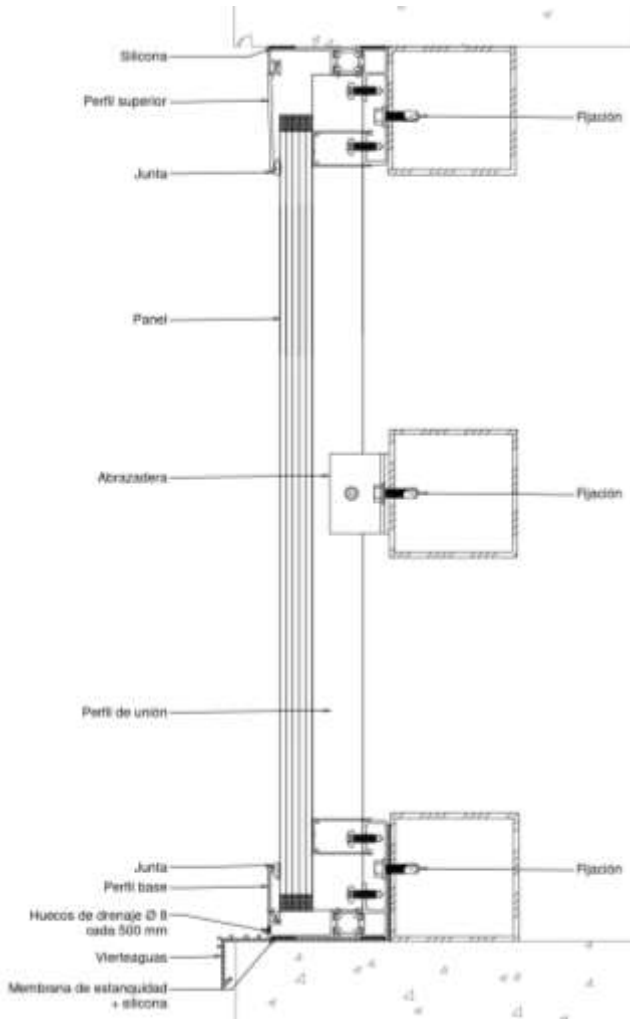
Instalación del sistema como cerramiento de fachada.
